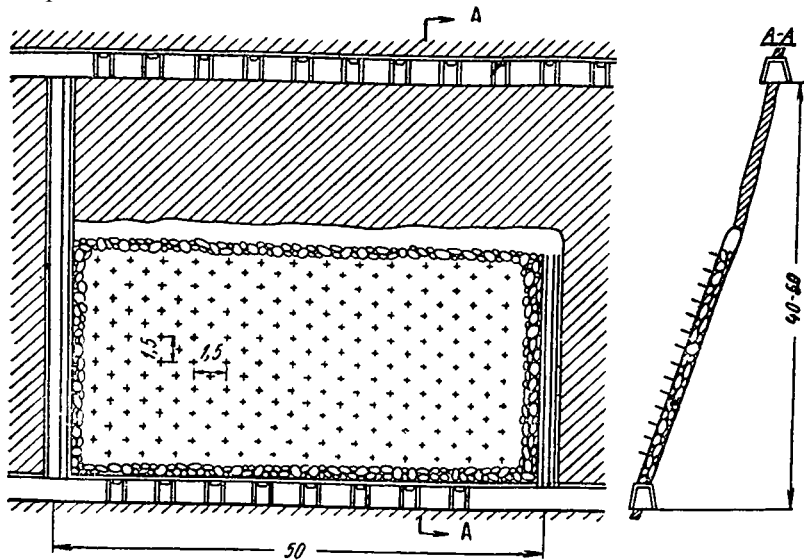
Общий вид блока с магазинированием руды и штанговой крепью
